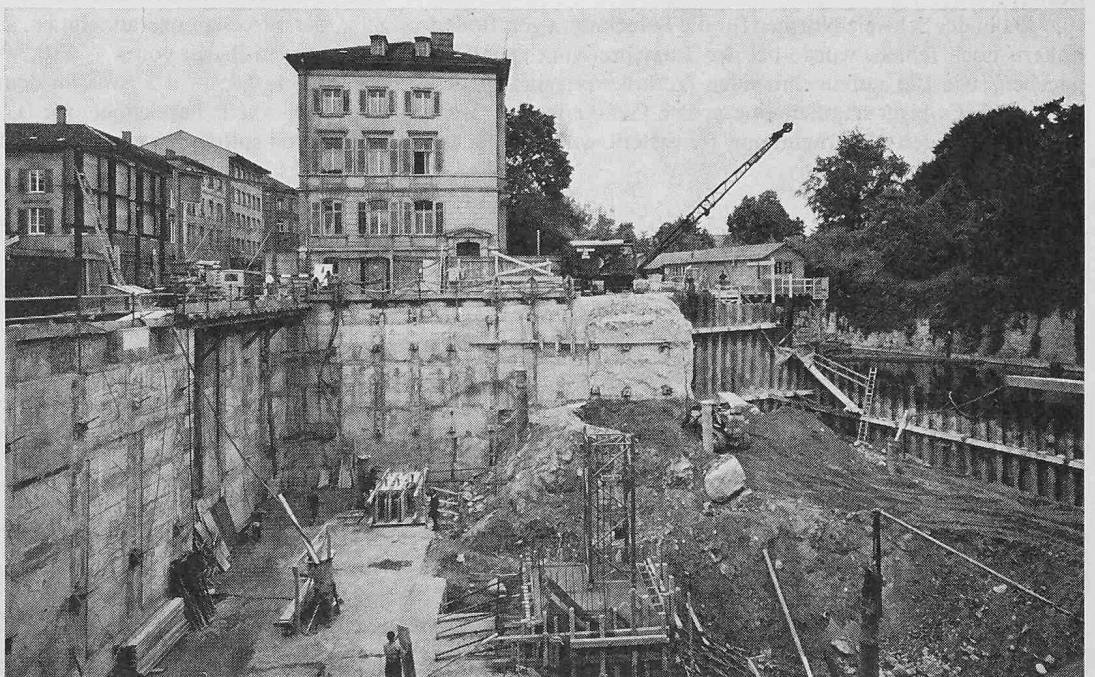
Baugrubenabschlüsse, links Rühlwand, Mitte unter dem Baukran Schlitzwand, rechts Spundwand gegen den Schanzgraben
